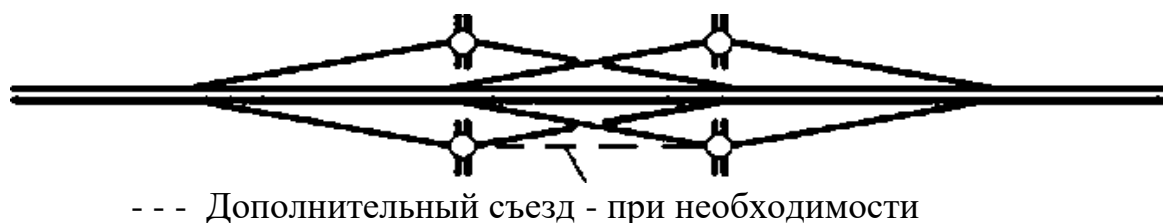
Схема планировочного решения с пересекающимися съездами
